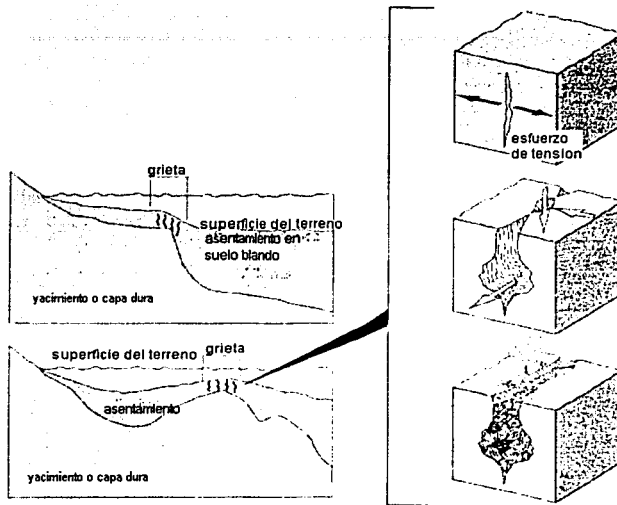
Crecimiento progresivo de grietas o fisuras verticales.
